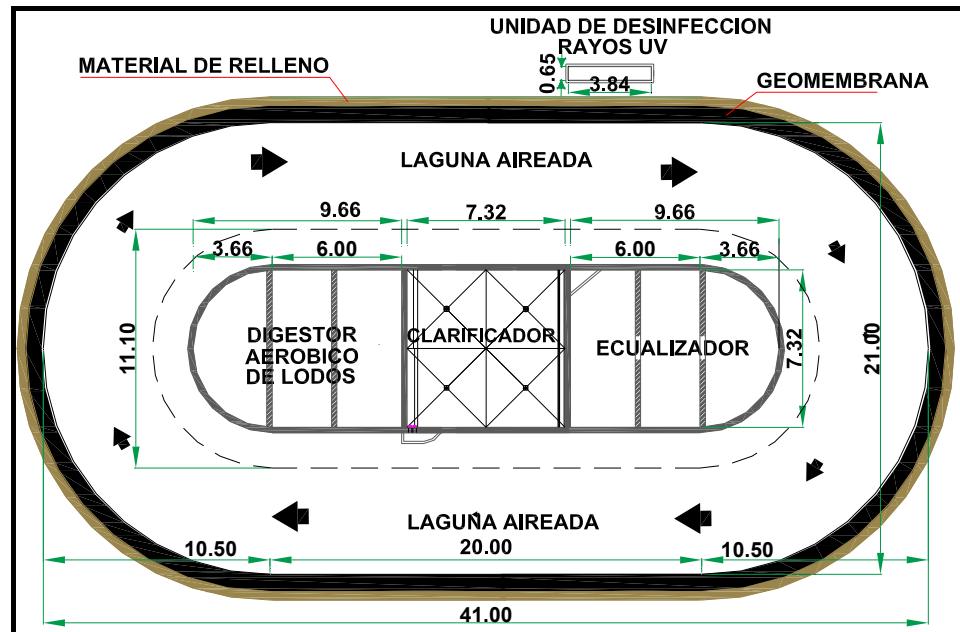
Esquema en planta de las dimensiones del STARD ⁽⁸⁶⁾.
